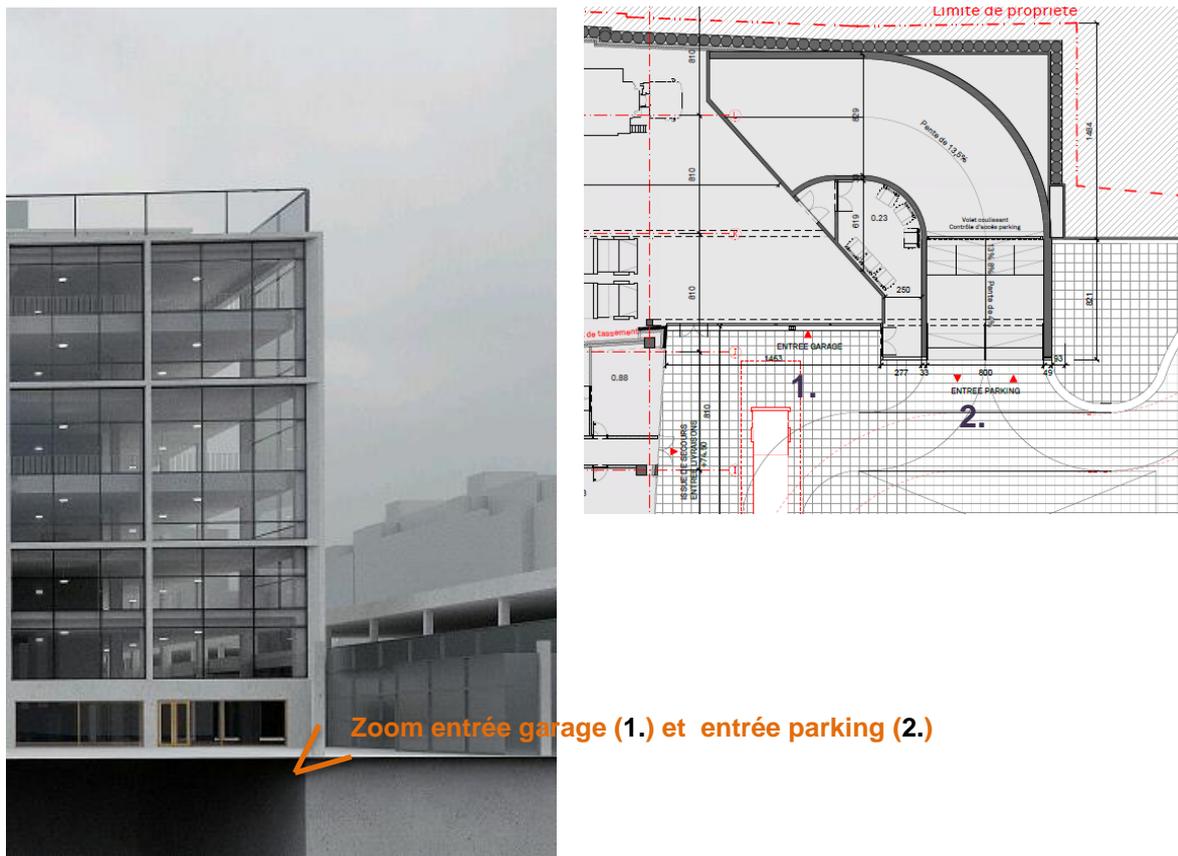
Zoom entrée garage et entrée parking (Source : MDW/V+)
